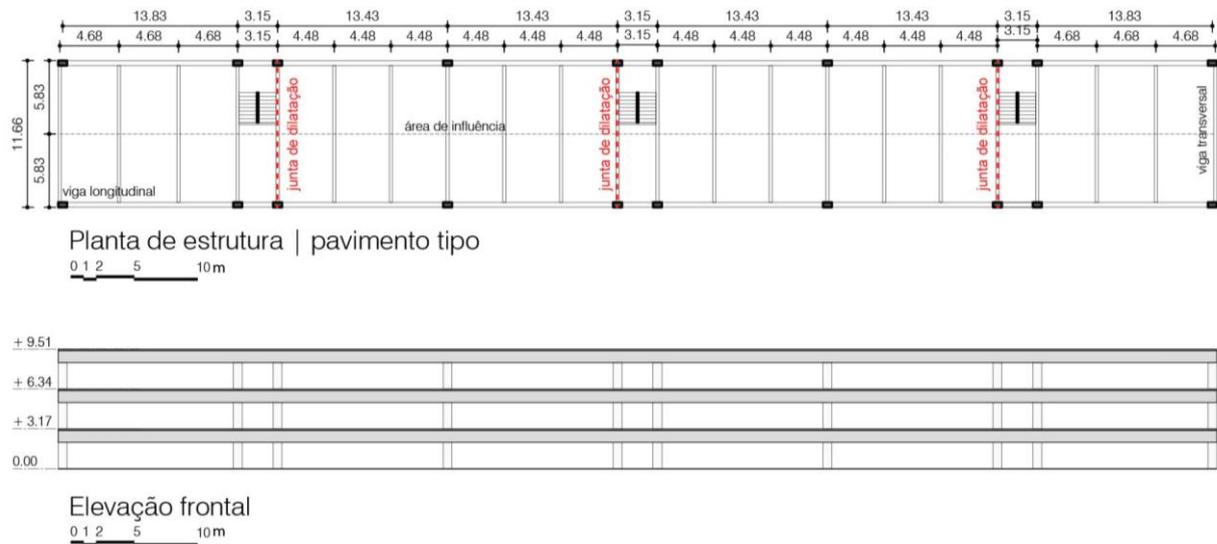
Planta estrutural e elevação frontal da simulação 3: Elaborado pelo autor
